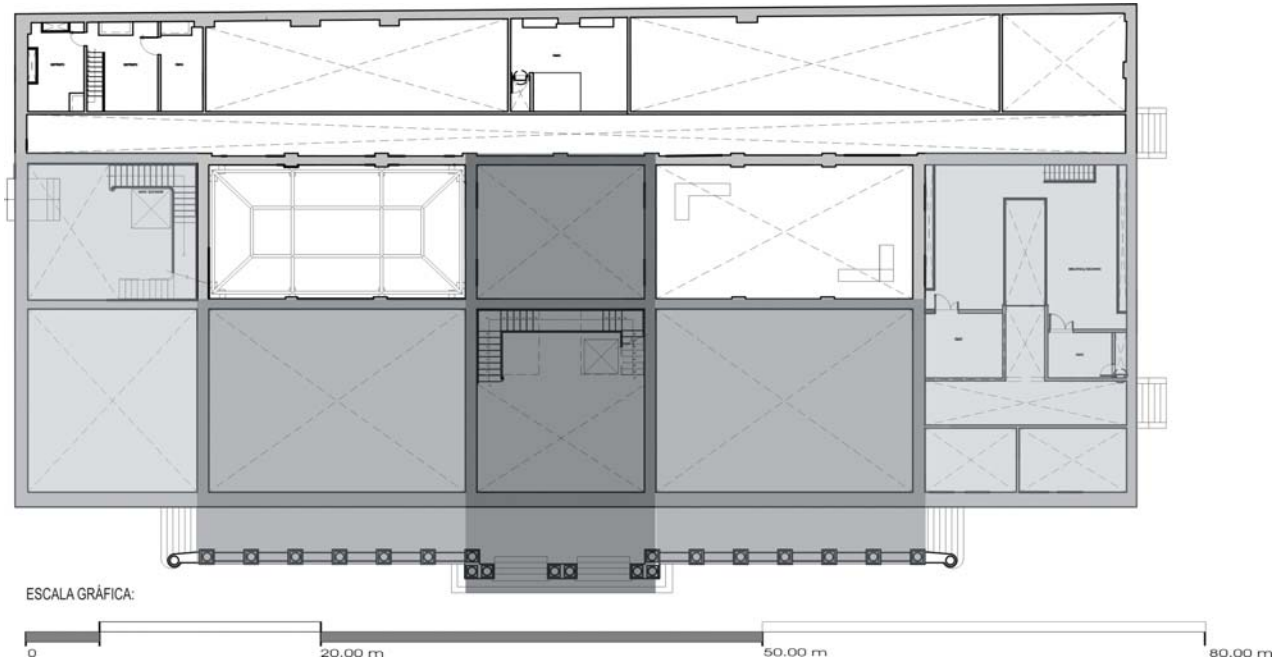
Relação Planta-Fachada – simetria mezanino.
